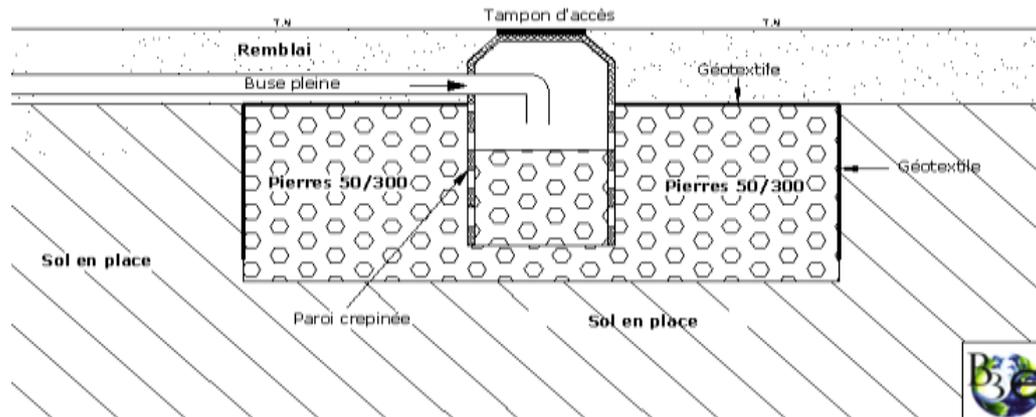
Coupe schématique d'un puits d'infiltration (source : B3E)
